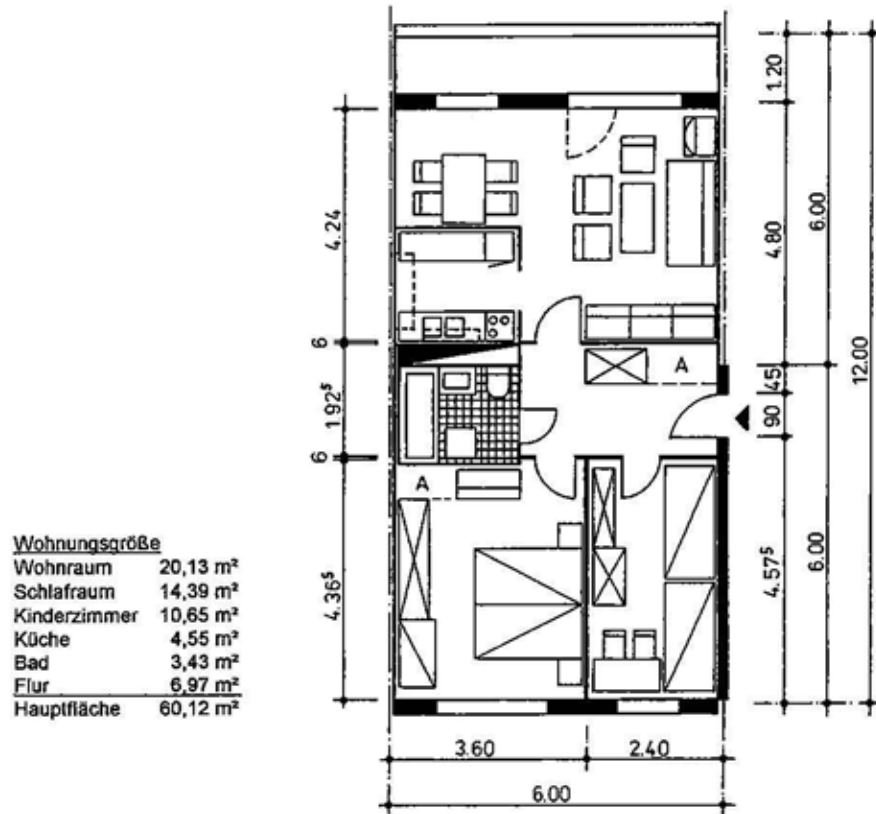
Grundriß einer 3-Raumwohnung mit Innenküche
